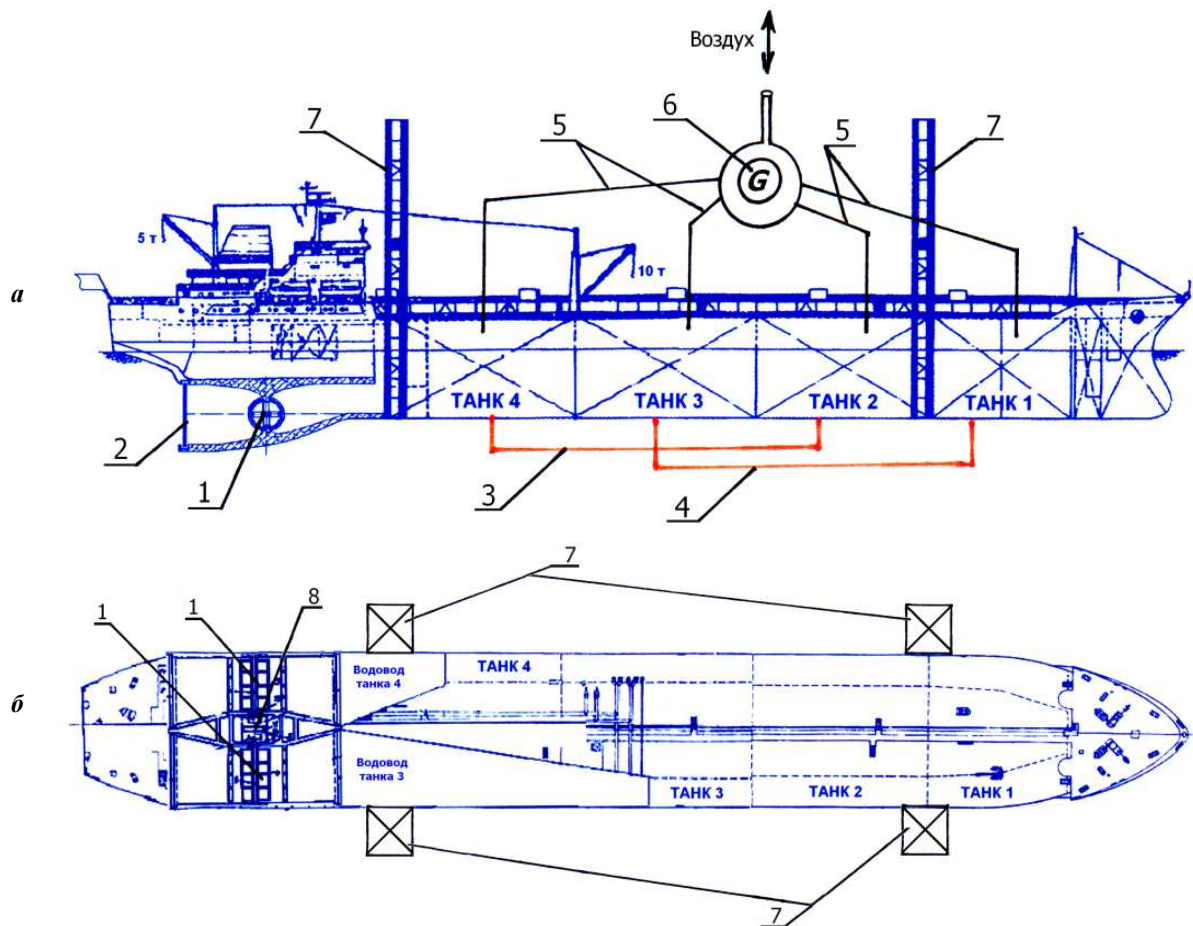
Реконструированная схема наплавного блока НГЭС (а – вид сбоку, б – вид сверху): 1 – ортогональная турбина, соединенная через дифференциалы с генератором; 2 – задвижки, перекрывающие входы в водоводы; 3 – водоводы, соединяющие танки 2 и 4; 4 – водоводы, соединяющие танки 1 и 3; 5 – воздуховоды, объединяющие все танки и предназначенные для сбора сжатого воздуха и направления его в пневмотурбину; 6 – пневмотурбина с генератором; 7 – подвижные выдвигные стойки, для установки наплавного блока на грунт; 8 – генератор, соединенный с ортогональными турбинами через дифференциалы
